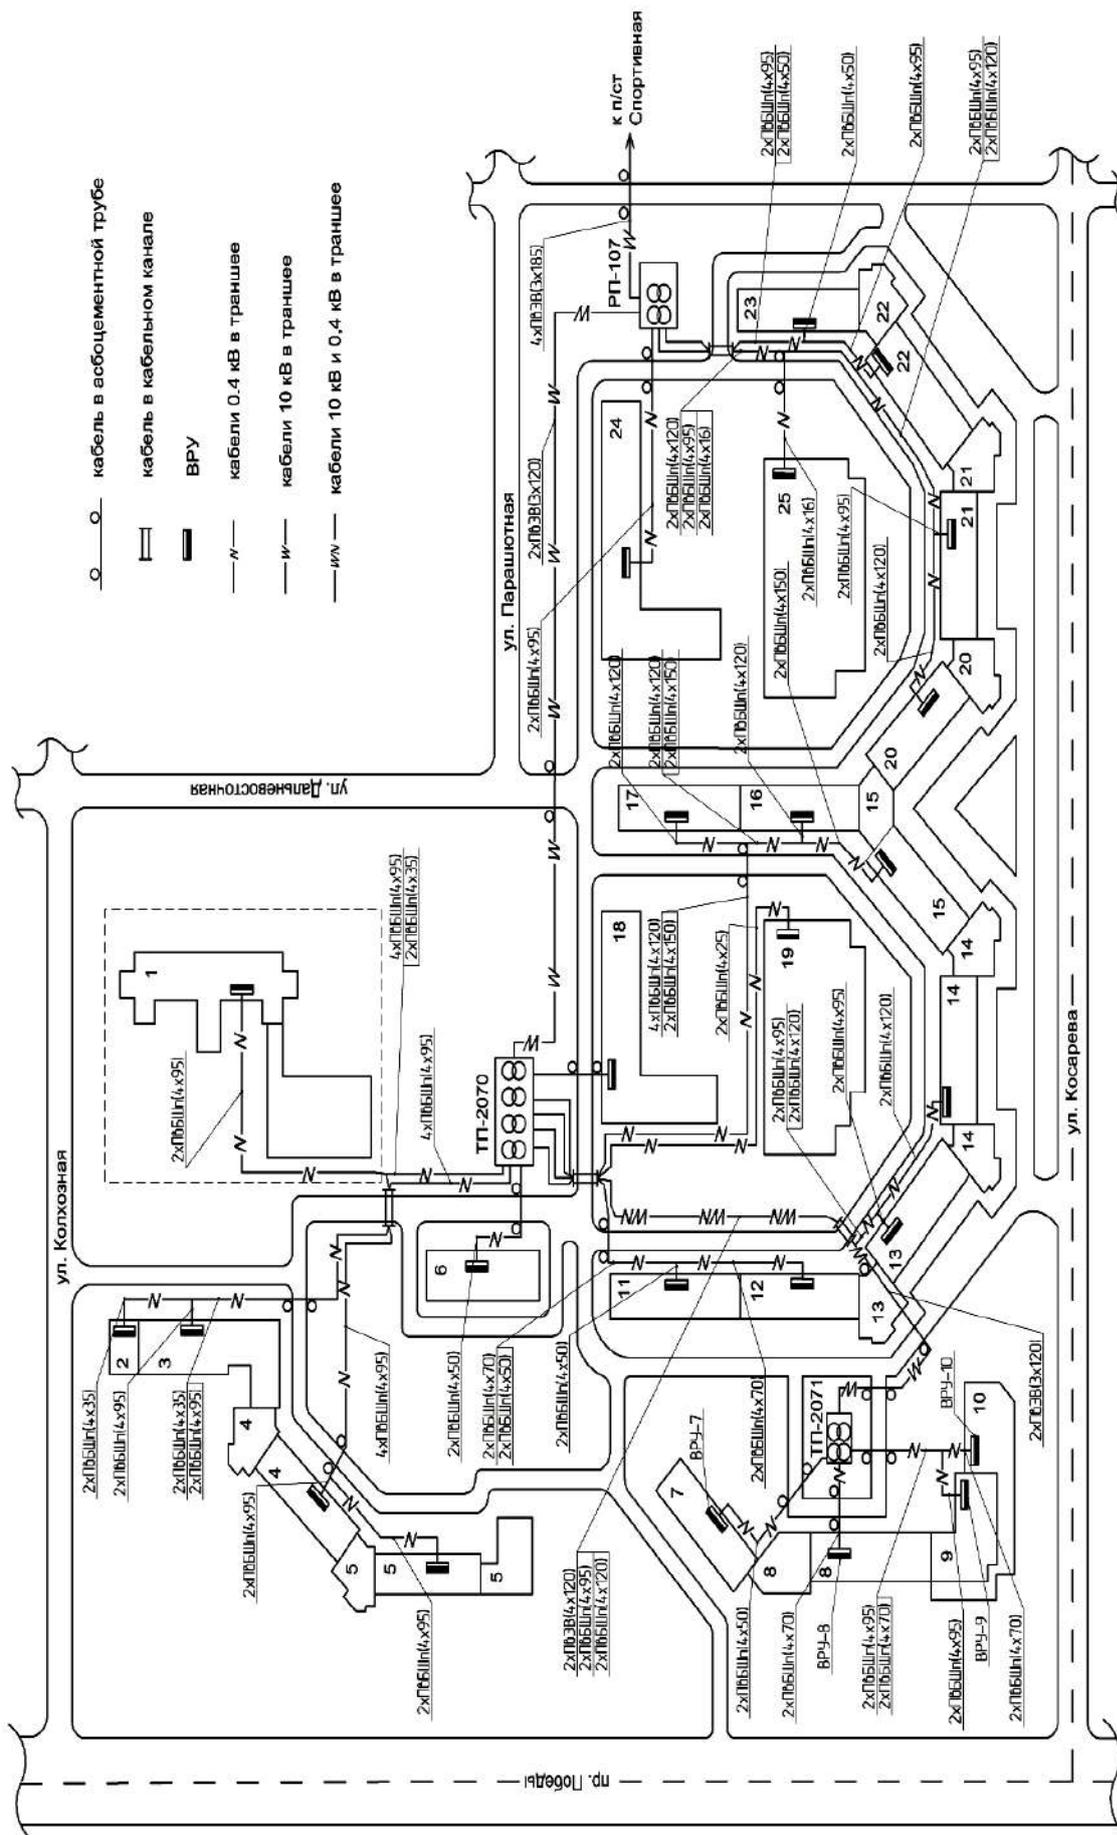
План жилого микрорайона с внутриквартальными электрическими сетями
